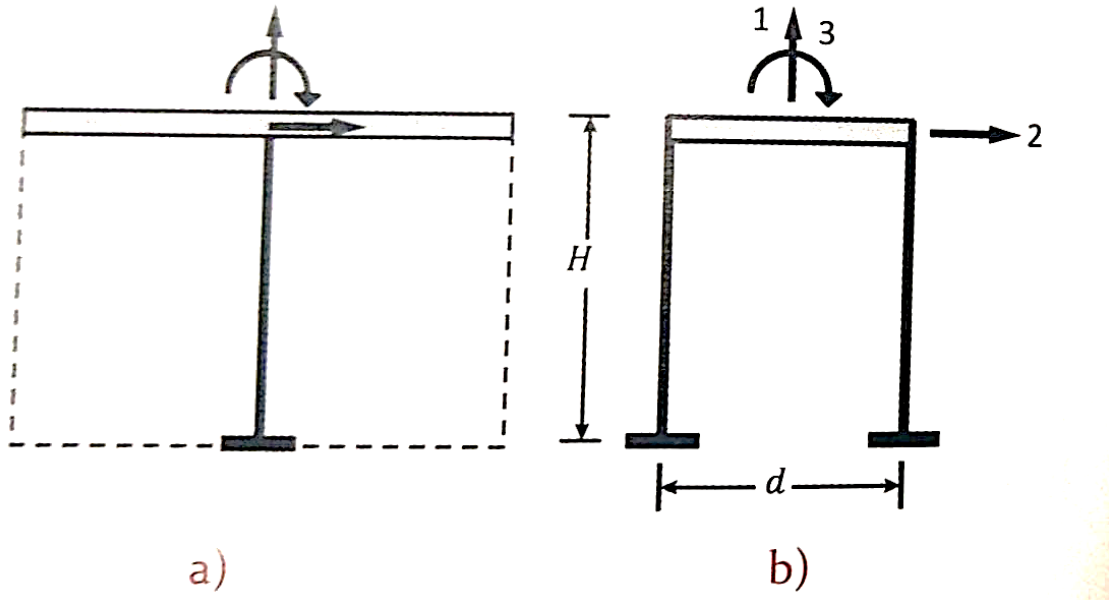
Modelo de un muro en voladizo con 1 barra (a) y 2 barras (b) (Sociedad Mexicana de Ingeniería Estructural, 2019)
